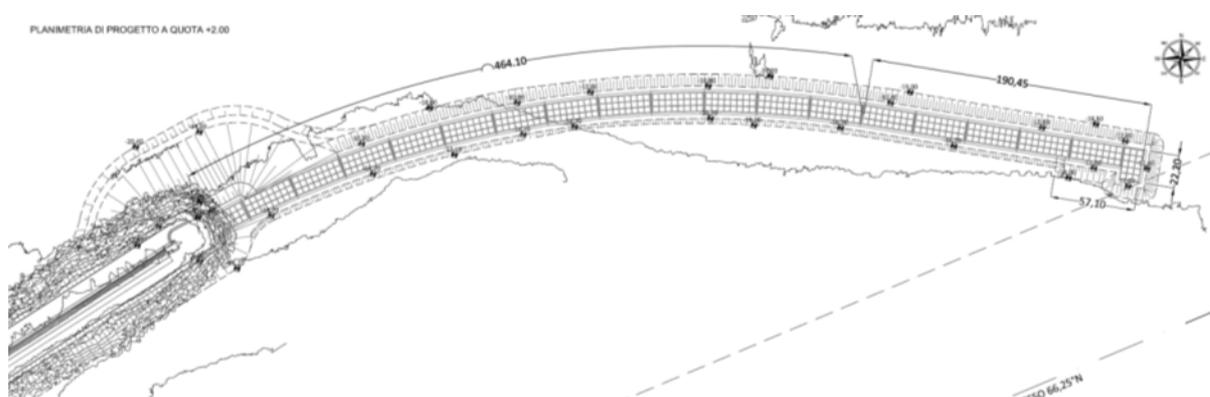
Planimetria prolungamento antemurale Molo di Ponente
